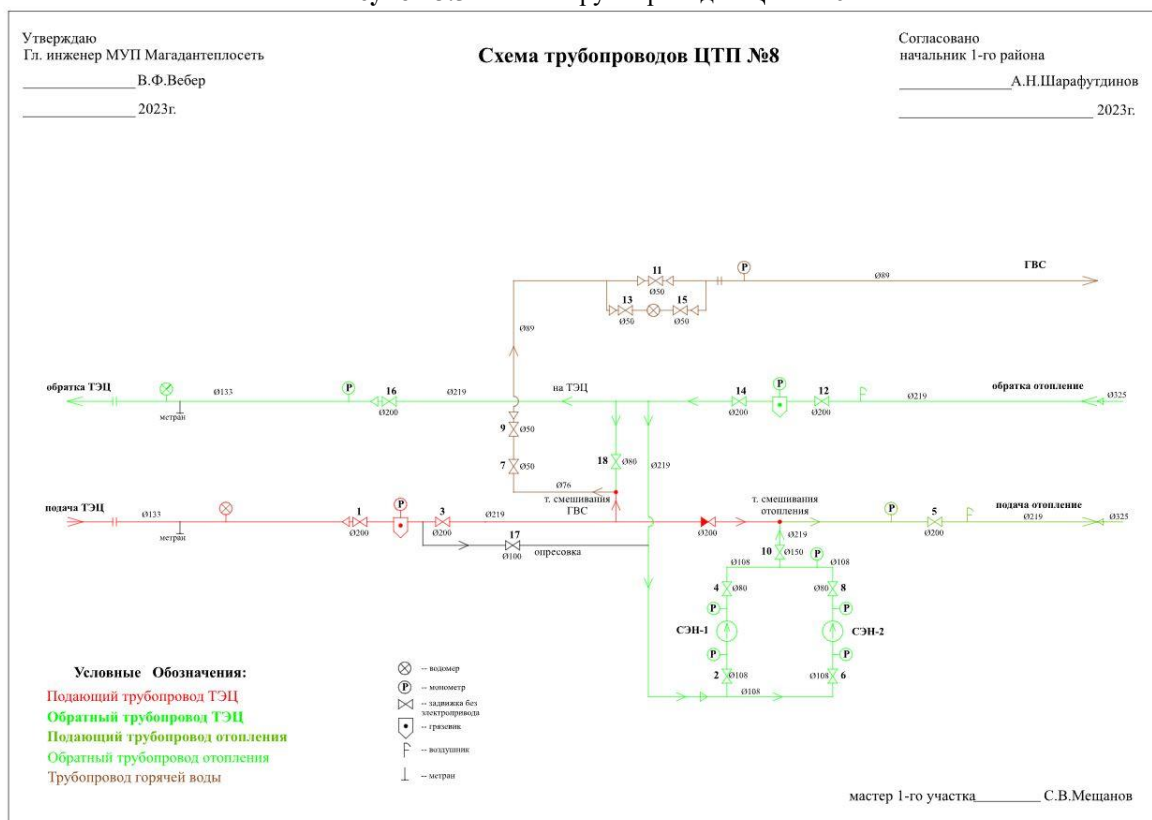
Схема трубопроводов ЦТП №8
